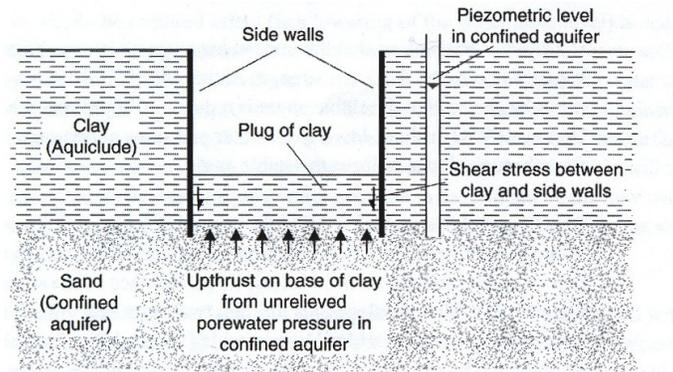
Levantamiento del fondo debido a la excavación en un suelo de baja permeabilidad sobre un acuífero confinado, en recinto delimitado por diafragma (PREENE et al., 2004).
